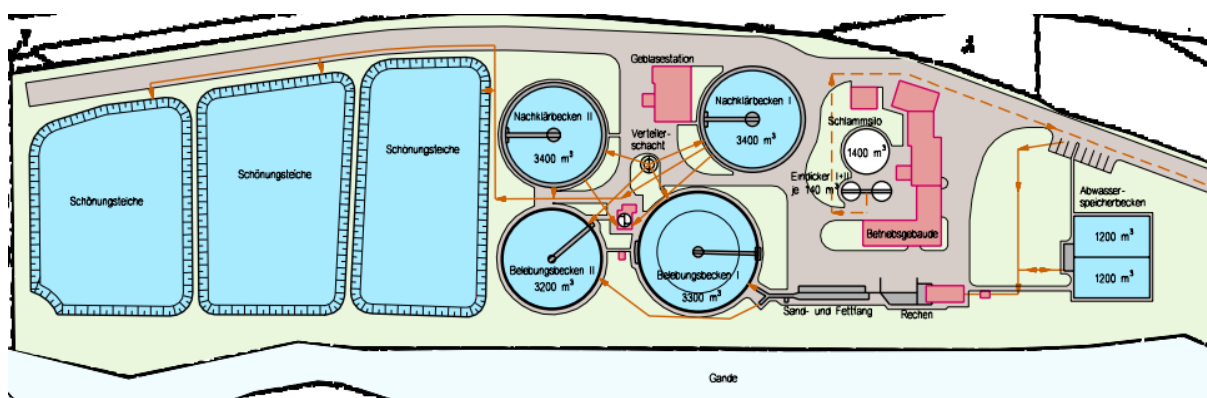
Lageplan Kläranlage Bad Gandersheim
